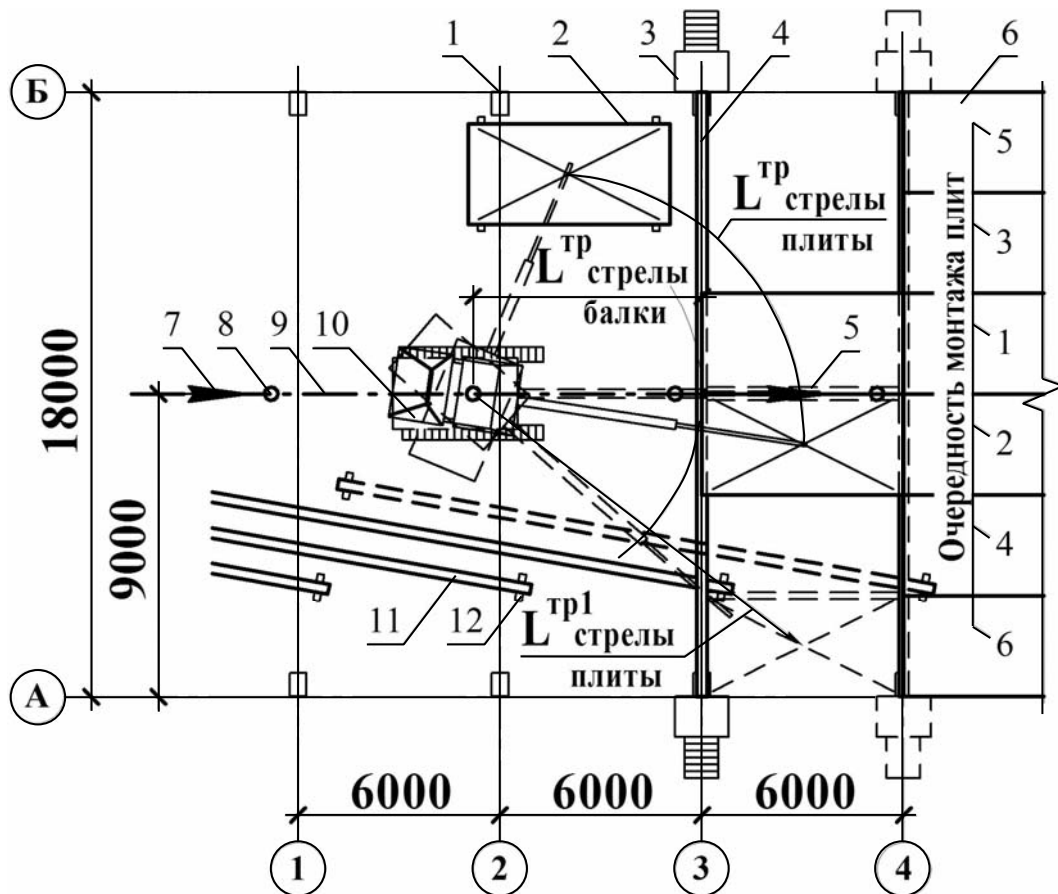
Примерная схема монтажа подкрановых балок поворотом стрелы крана и «вира» грузом
